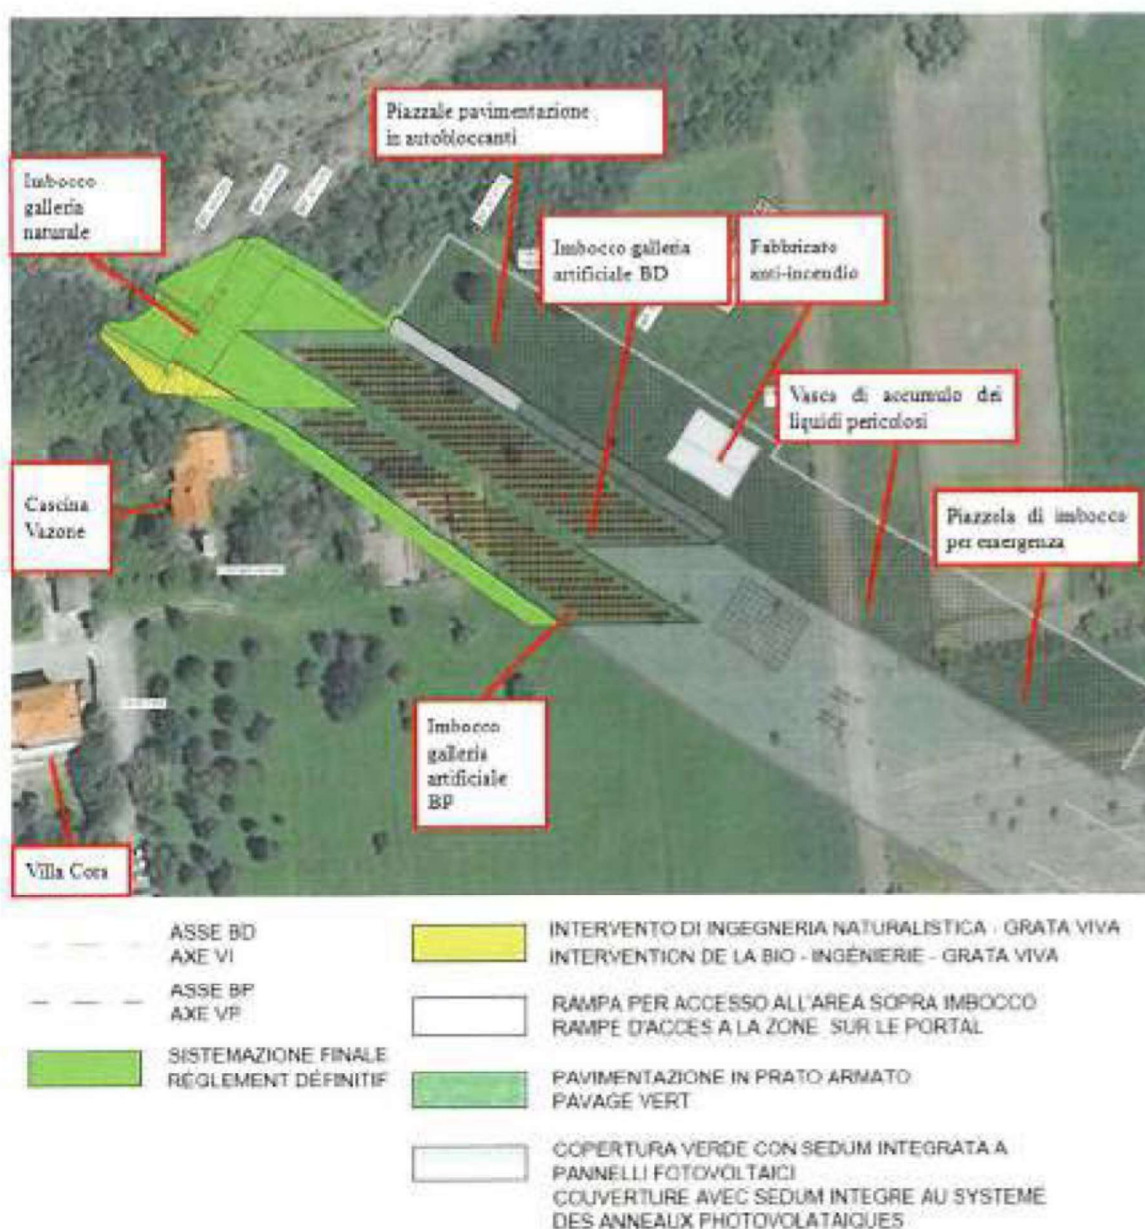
Planimetria su ortofoto dell'Imbocco Est del Tunnel di Base
